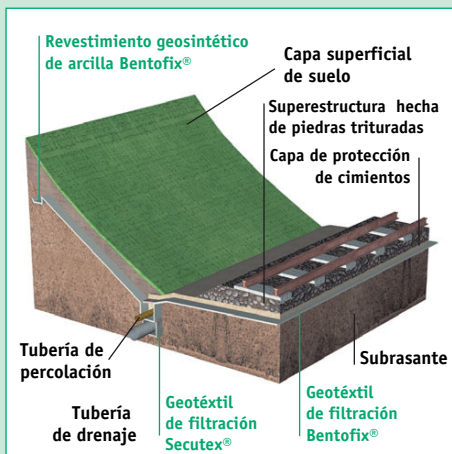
Sistema de sellado Bentofix® en la construcción de vías férreas para la protección de las aguas subterráneas.
